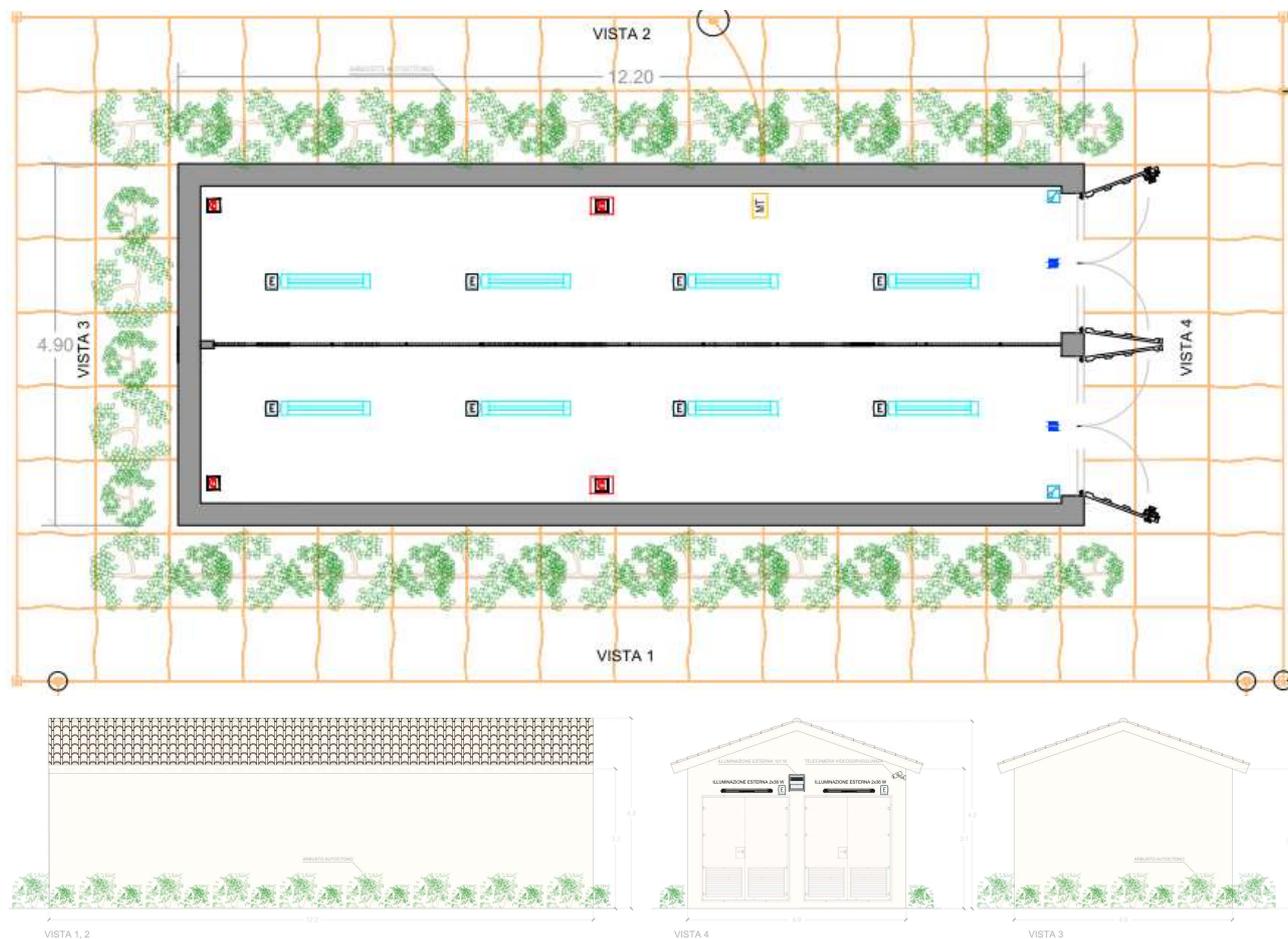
Planimetria e prospetti Cabina magazzino
